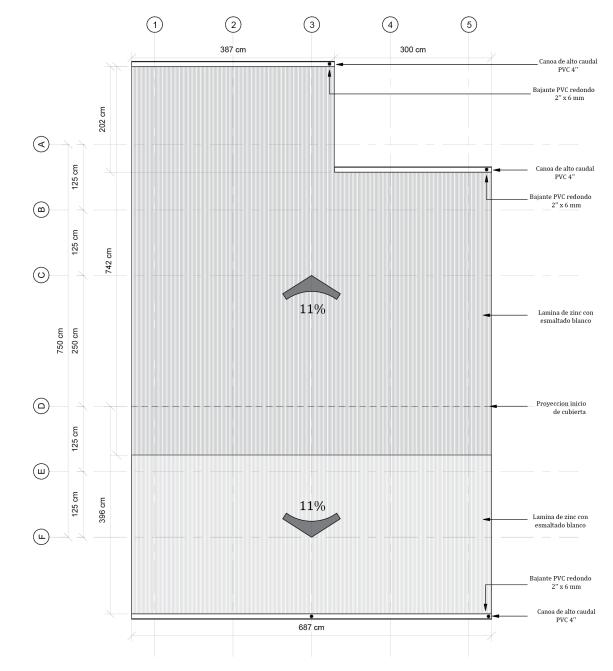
Planta de Techos Gran Área Metropolitana Fuente: Elaborado por autor
